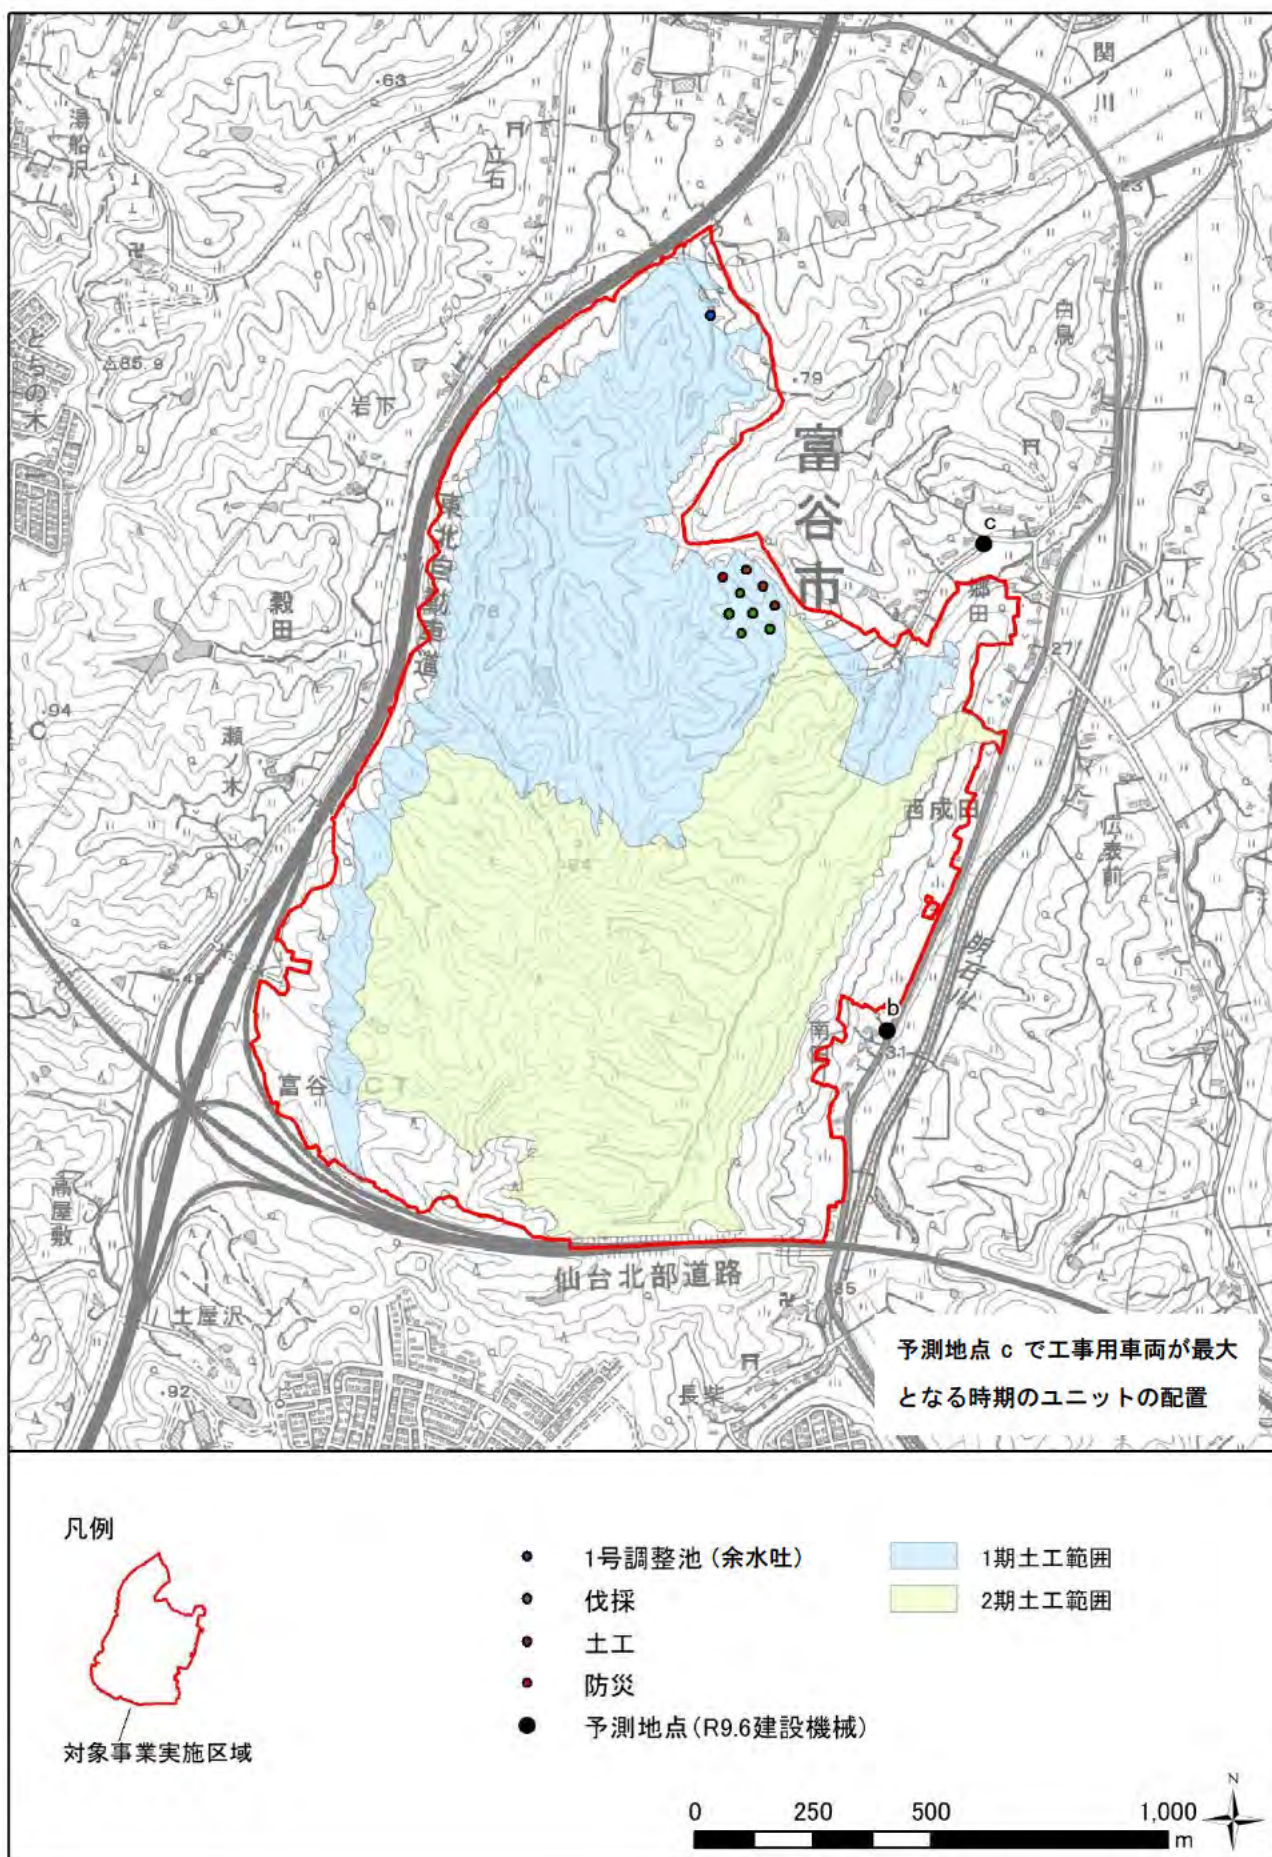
複合騒音予測時期の施工範囲及びユニットの配置 (R8.3 予測地点c)
